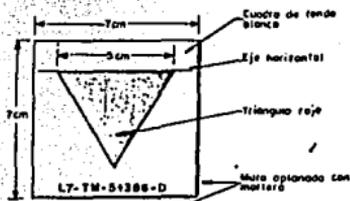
TESTIGO EN MUROS DE ESTRUCTURAS
